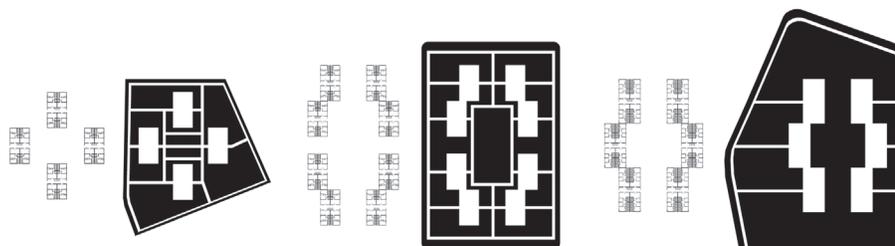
Plantas esquemáticas de tipos de disposiciones de bloques formando conjuntos. Elaboración sobre planos de los Conjuntos Joaquín Edwards Bello en San Joaquín, 1970; Villa México en Cerrillos, 1970; y Jaime Eyzaguirre en Ñuñoa y Macul, 1975. Archivos Direcciones de Obras Municipales correspondientes.
